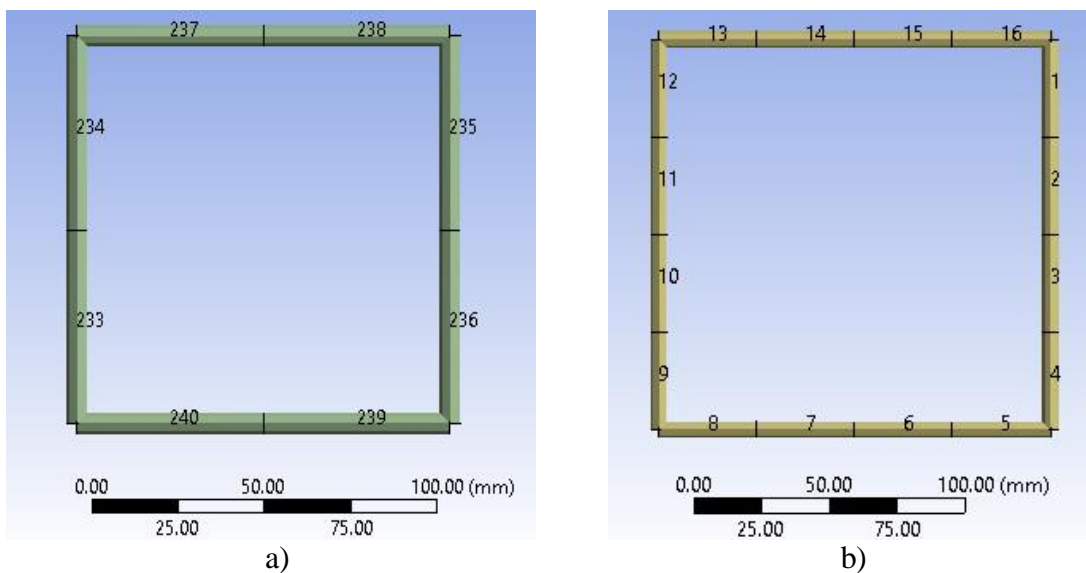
Discretización del refuerzo transversal. a) Vigas b) columnas.
